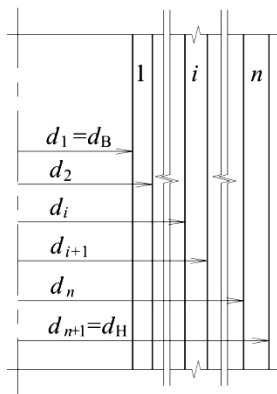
Расчетная схема многослойной цилиндрической стенки дымовой трубы
